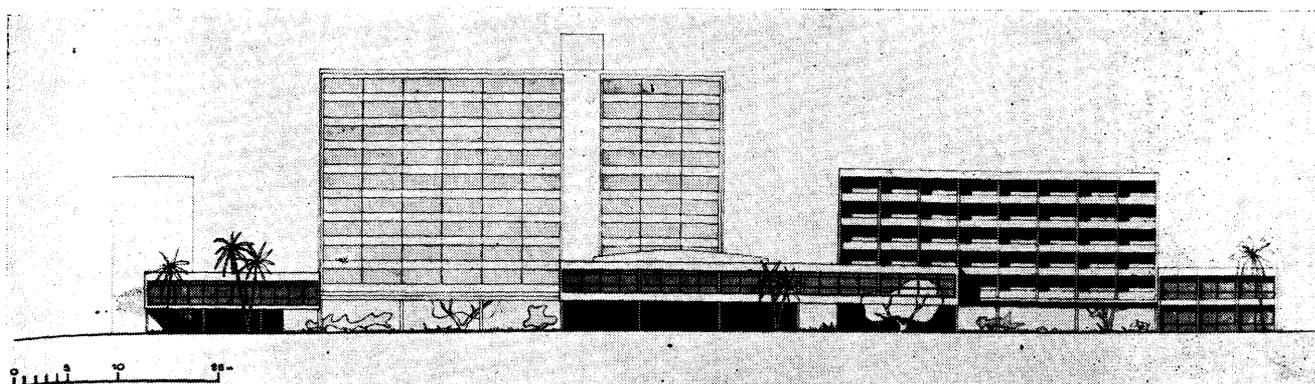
Façade sur l'avenue Charles-de-Gaulle.
